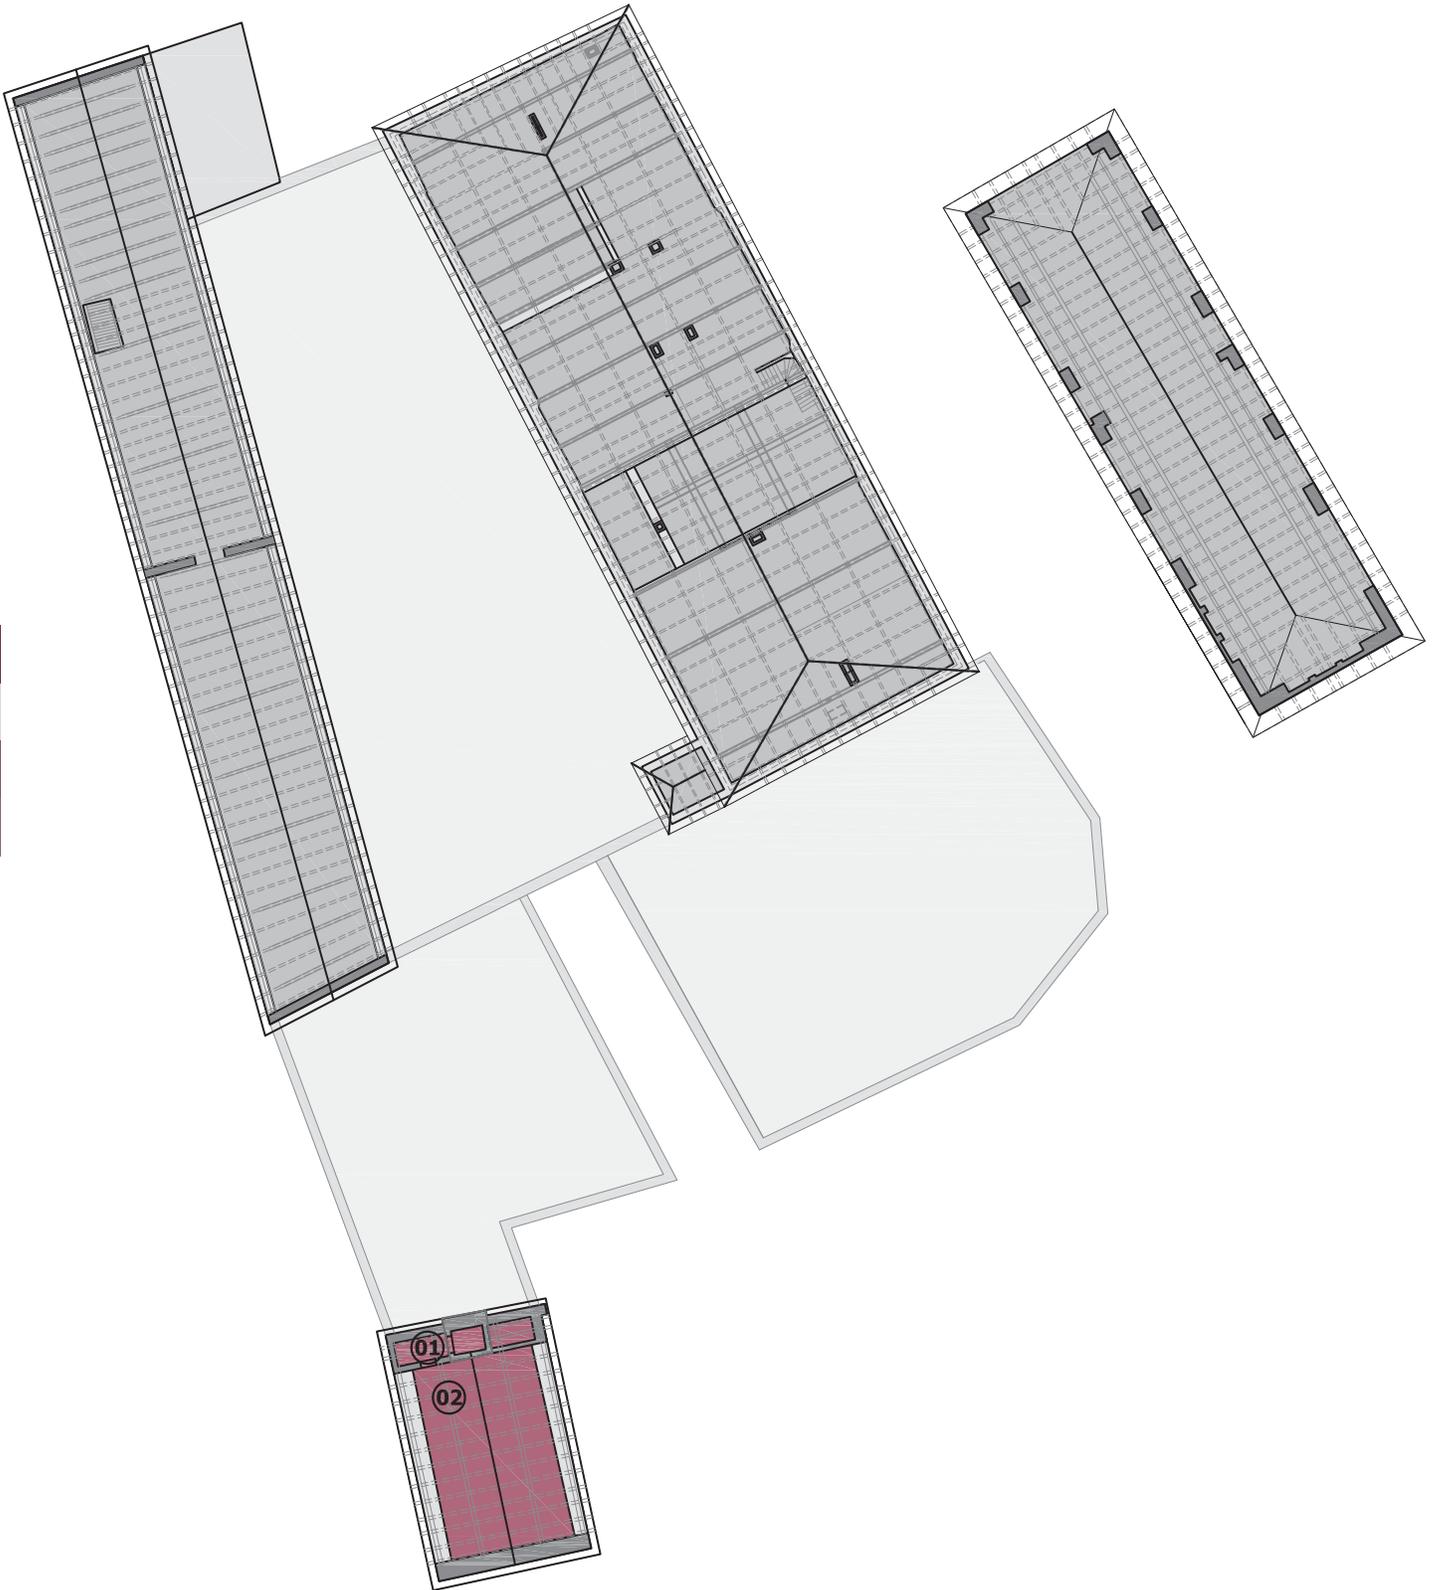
Übersichtsplan Dachgeschoss, Kirche
